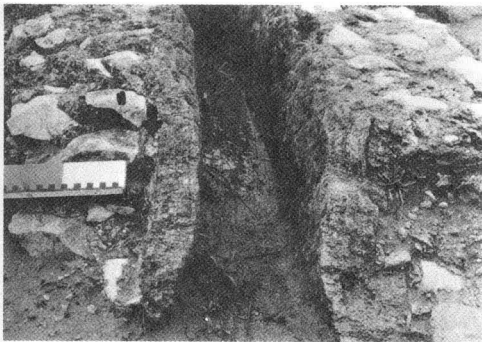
Barragem da Ponte dos Mouros. Pormenor do paramento de jusante.
